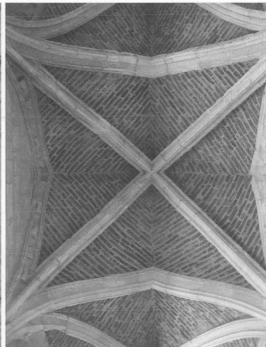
Bóvedas con plementería de ladrillo, antes de la restauración (foto de Eduardo Barceló 2007)
